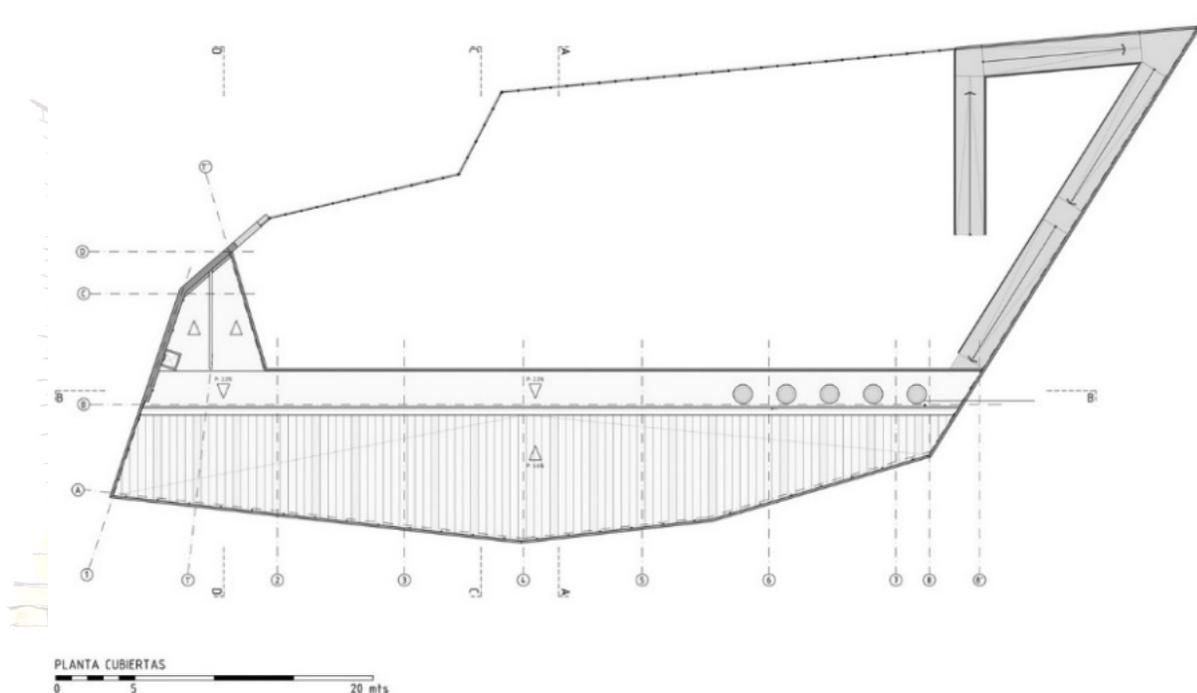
/ Institución Rural Chaparral/ Planta de Techos/ Año 2015/ Obtenido de PlanB
